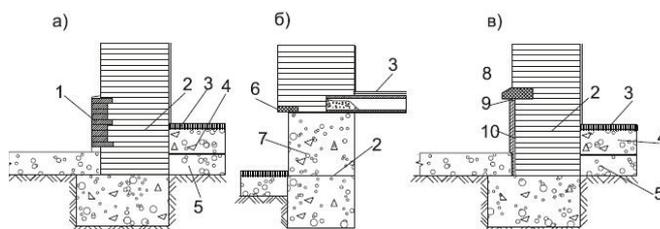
Цоколи кирпичных стен: а — облицованный отборным кирпичом; б — из бетонных блоков; в — облицованный тесаными плитами из натурального камня: 1 — лицевой кирпич; 2 — гидроизоляционный слой; 3 — пол первого этажа; 4 — бетонная подготовка; 5 — уплотненный грунт; 6 — кордон из железобетонных брусков; 7 — стена подвала из бетонных блоков; 8 — кордонный камень; 9 — осадочный зазор; 10 — каменные плиты
